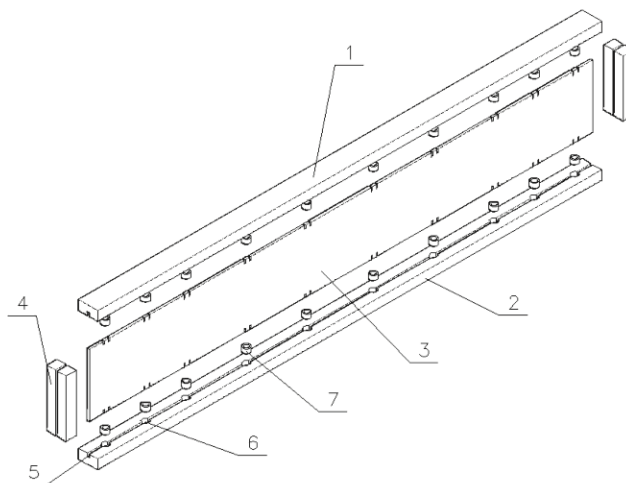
Общий вид новой конструкции клеефанерной балки в процессе сборки:
